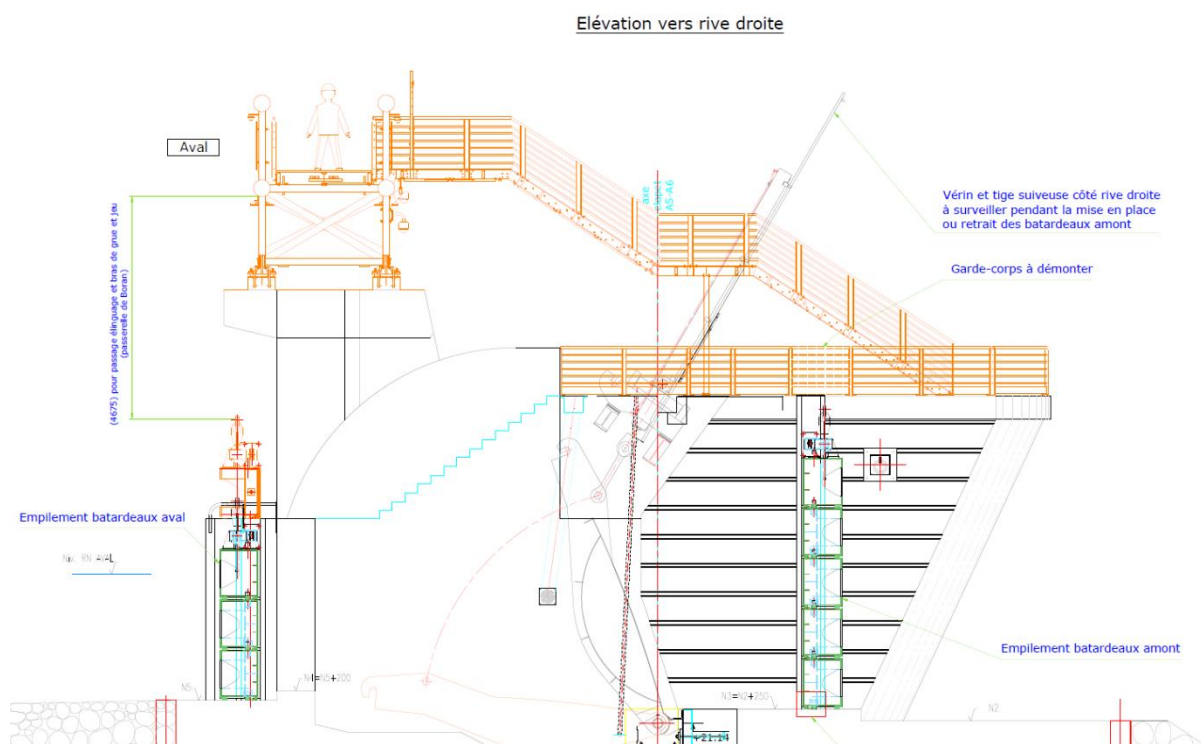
Vue en coupe du pertuis avec poutres empilées
